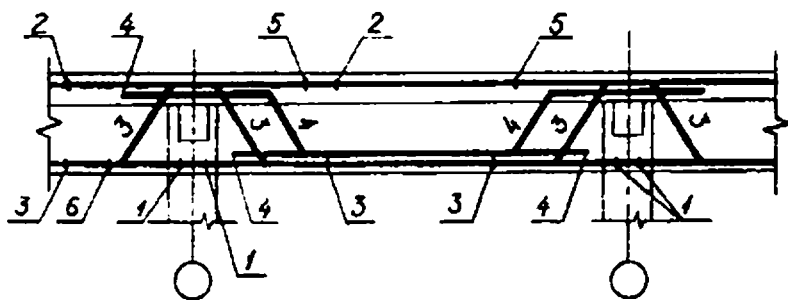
Пример нанесения номеров позиций арматурных стержней на схеме армирования монолитной железобетонной балки (поперечная арматура условно не показана)
